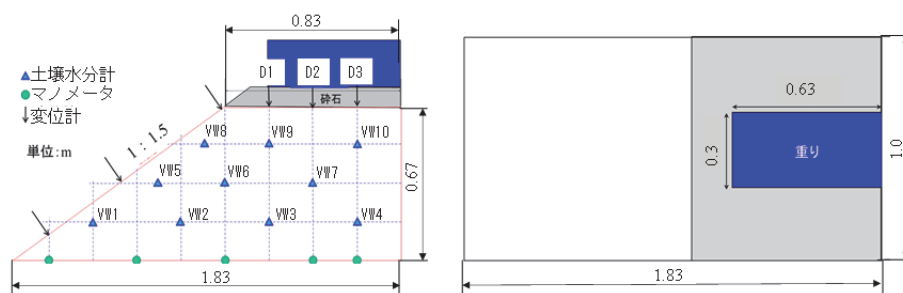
1/6 スケール盛土模型の図面と計測器配置図（左図：断面図、右図：平面図）
